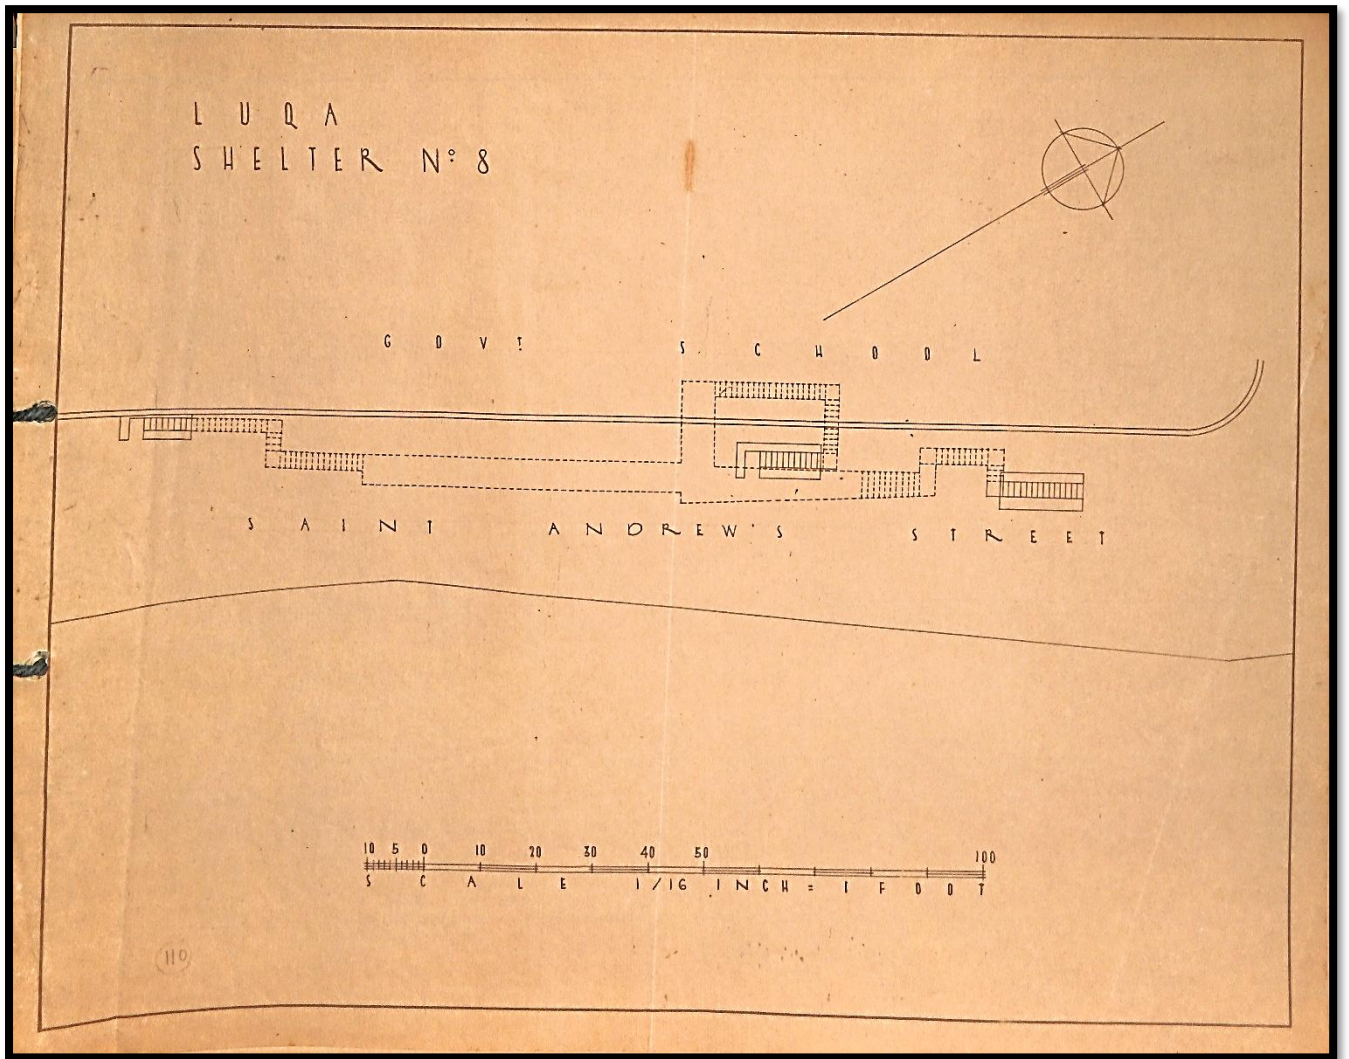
Planta do Abrigo nº8 "Saint Andrew's Street"
